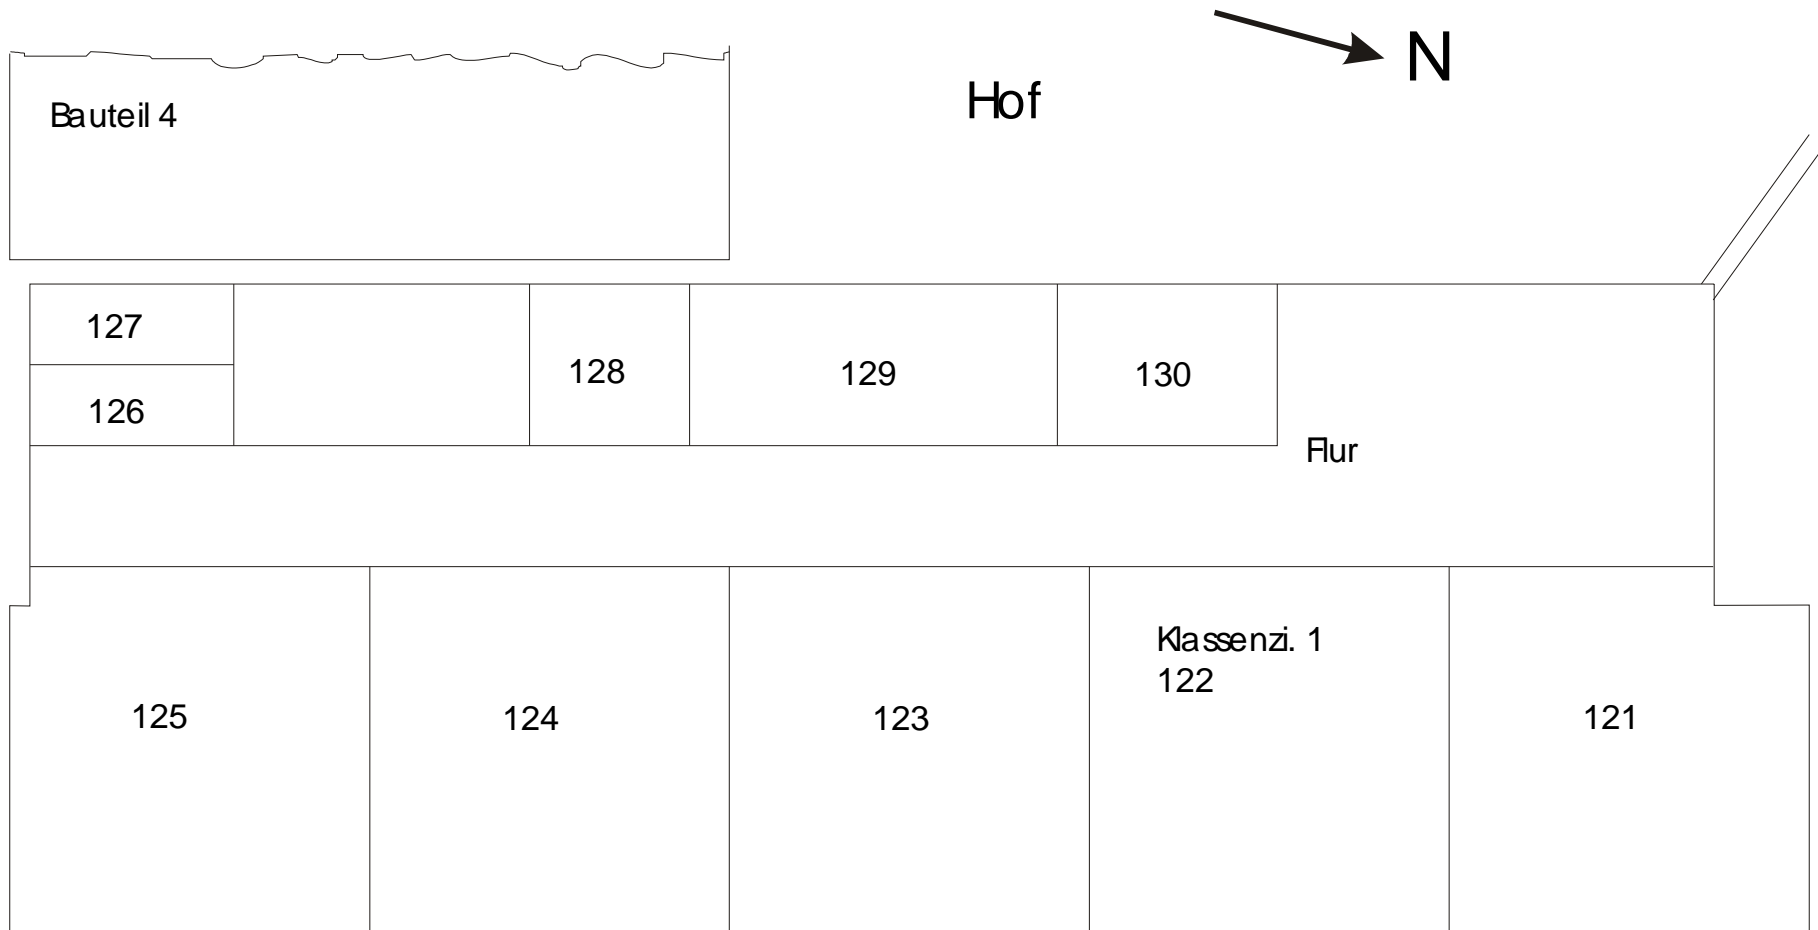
Bauteil 3 - Räume 1. Obergeschoss
